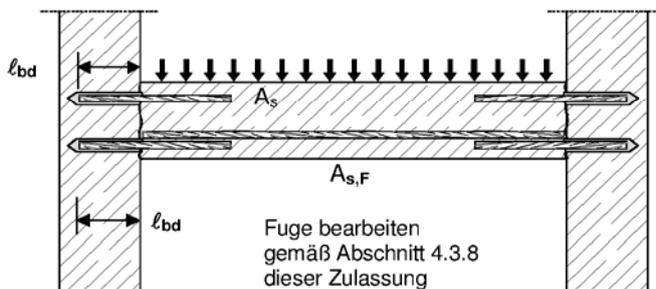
Bewehrungsanschlüsse überwiegend auf Druck beanspruchter Bauteile. Die Bewehrungsstäbe sind druckbeansprucht.
